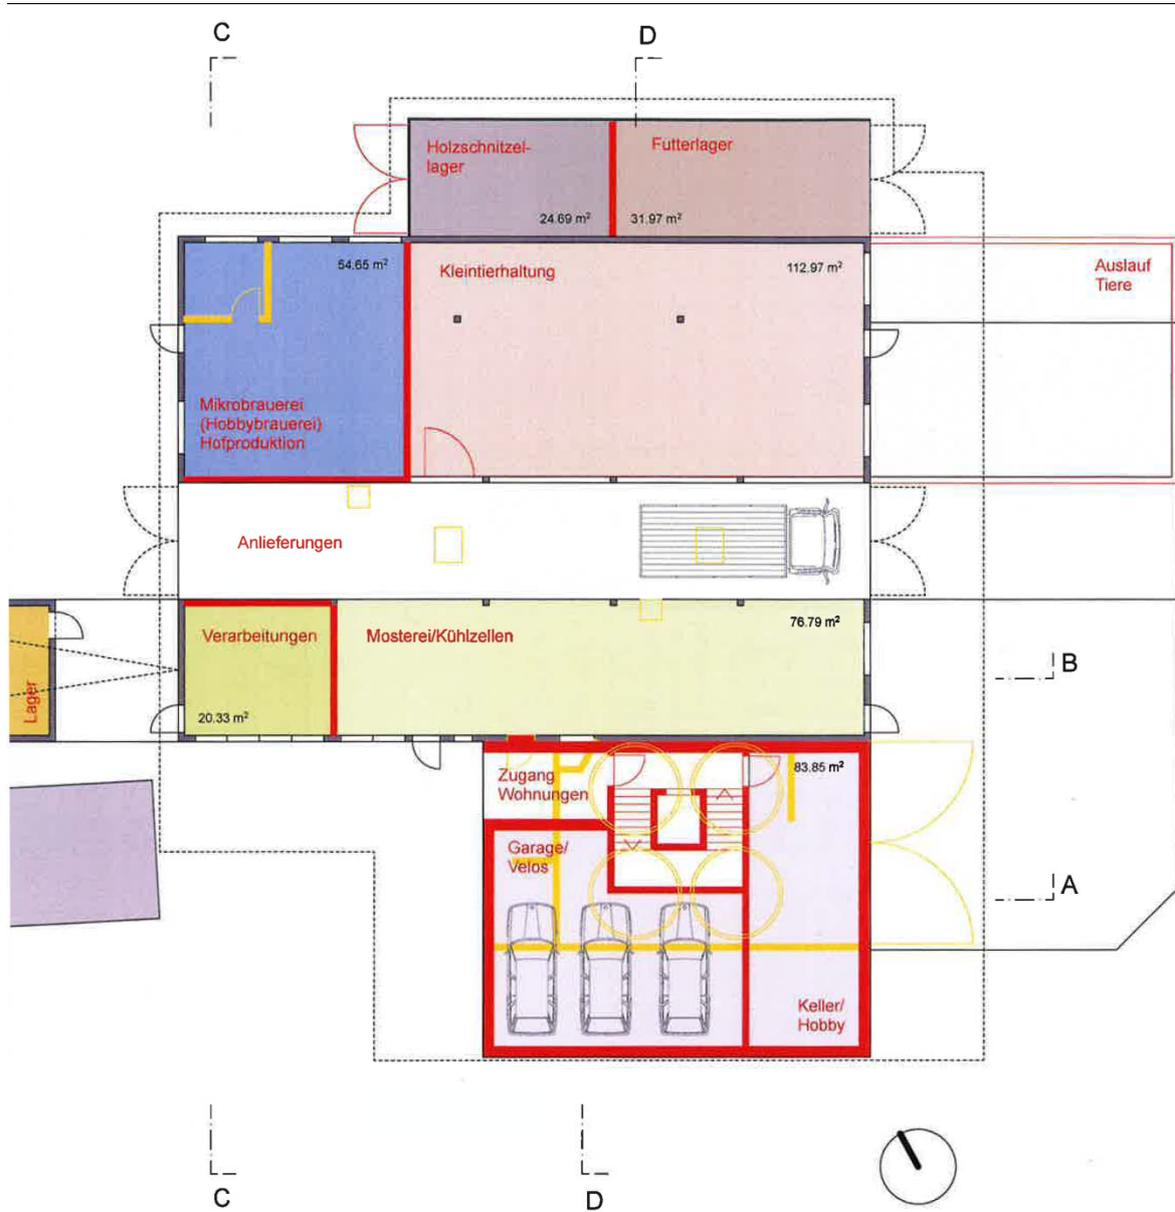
Entwicklungsstudie Allenwinden 12, Grundriss Erdgeschoss
